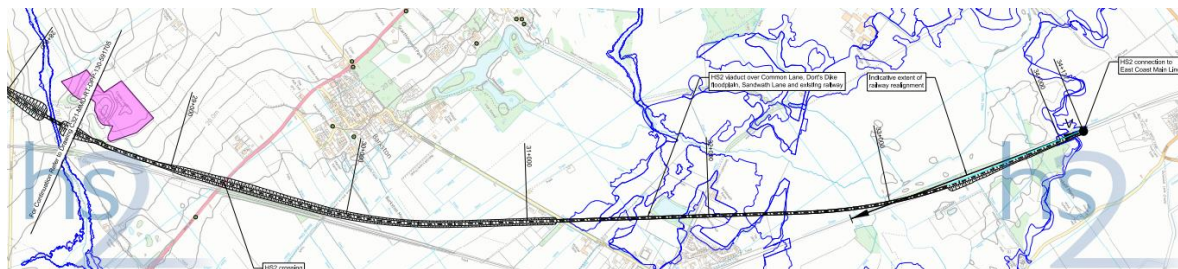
Planta do traçado viaduto sobre a Commom Lane, bacia de cheia de Dort's Dike (Unido, HS2 Phase 2b: Sharlston Common to Church Fenton route sheet 5).
